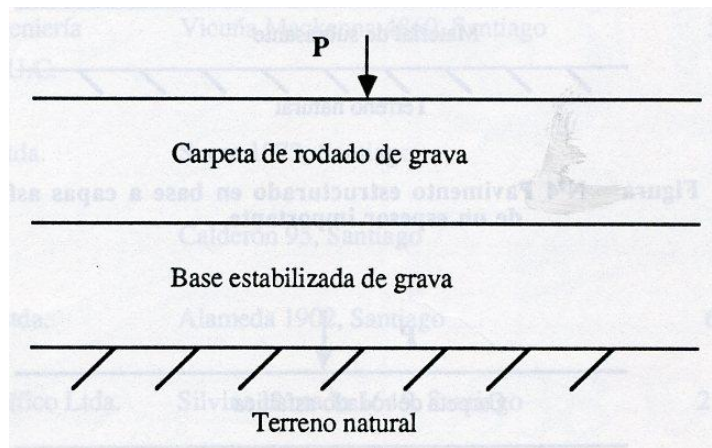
Pavimentos estructurados en base a capas granulares
